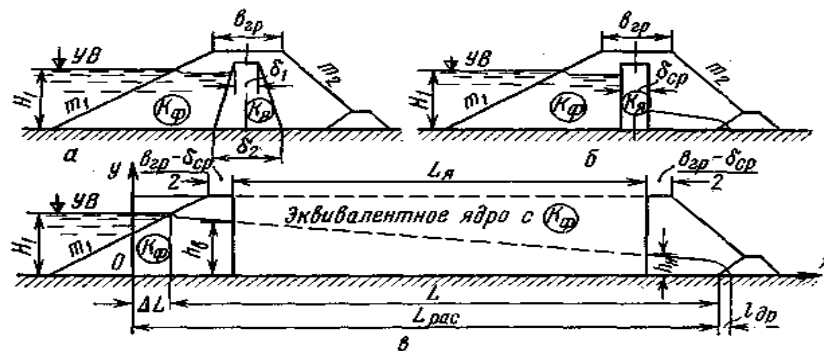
Схемы к фильтрационному расчету плотины с ядром:
